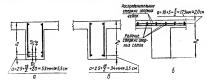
Схемы для определения полезной высоты сечения: a - B I пролете; 6 - B O II и III пролетах; <math>a - B опорных сечениях.
